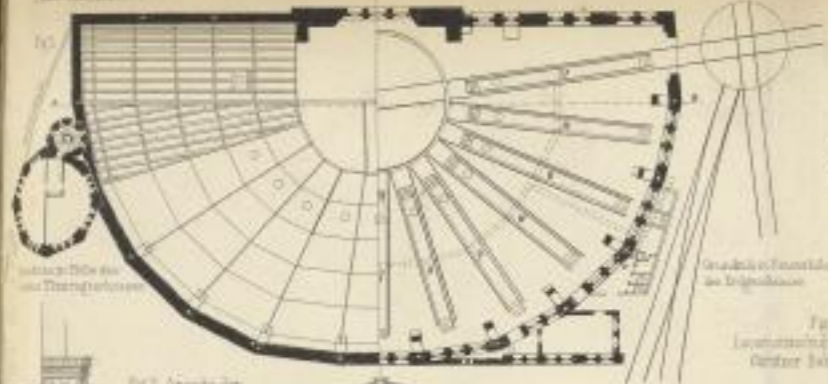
Plan der Lokomotivschuppen mit dem zentralen Einbaubau
